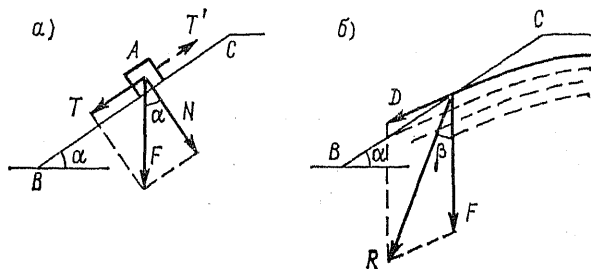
Схемы к расчету устойчивости откосов сыпучего грунта
